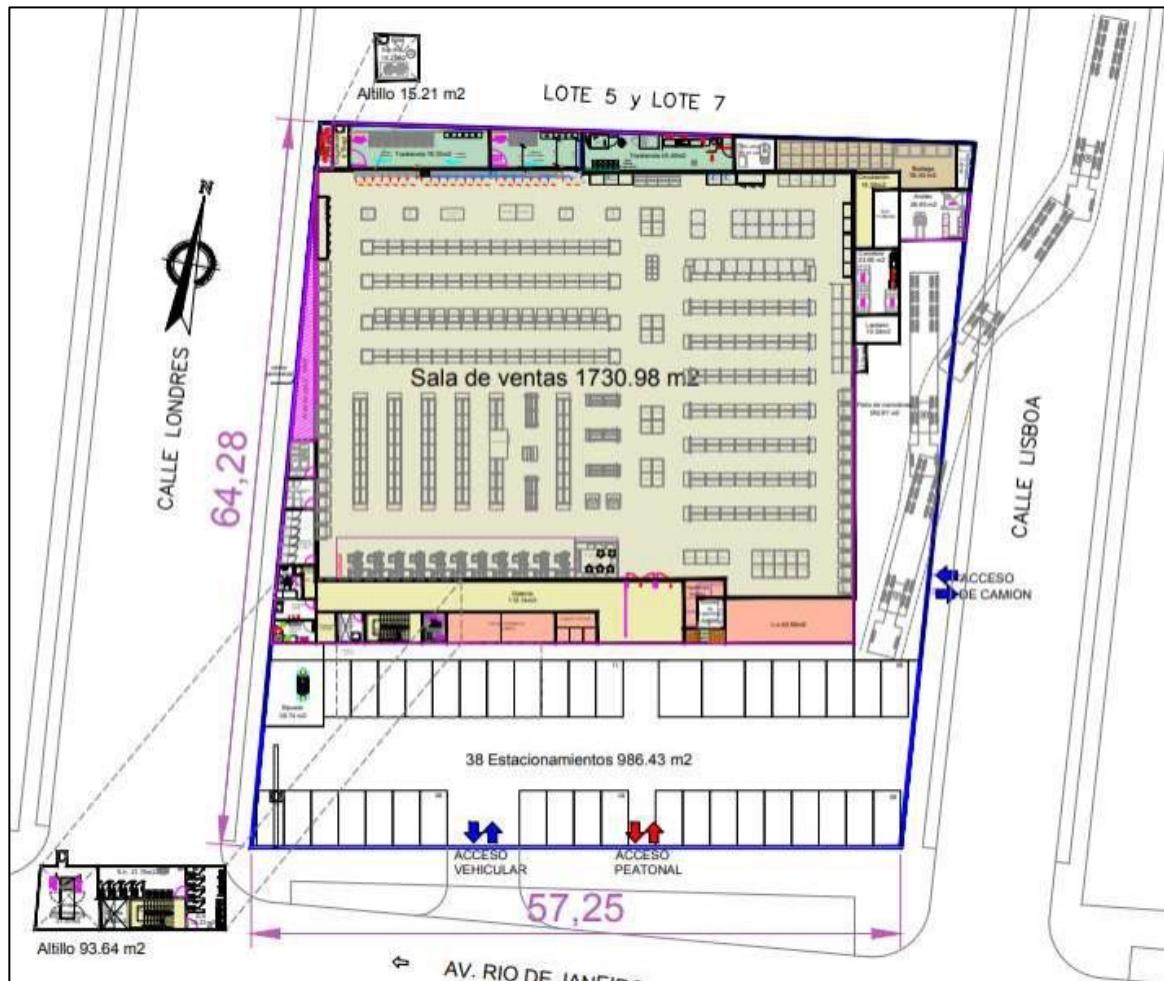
Plano de Cabida del Proyecto Ica Tinguiña.
